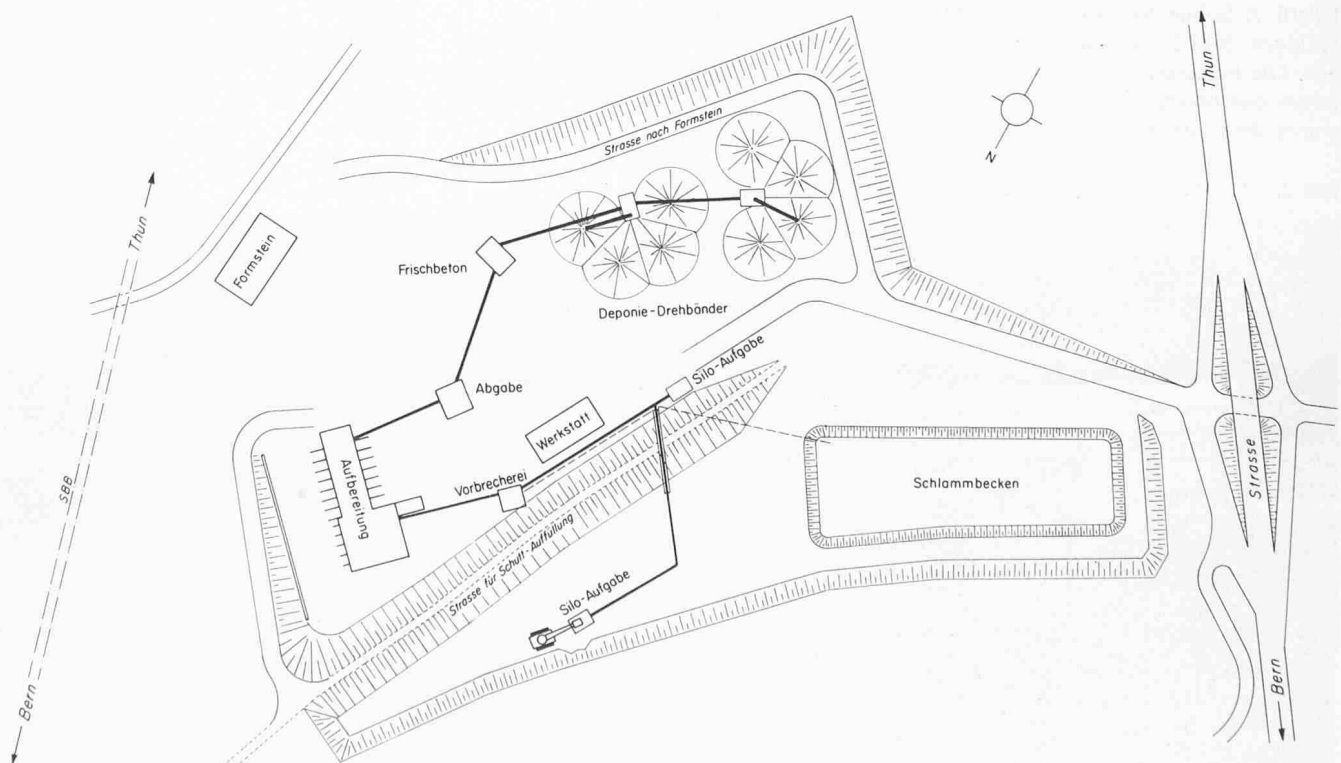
Lageplan der Anlagen der Bendicht Kästli & Söhne AG, Kieswerk Rubigen, Frischbeton AG und Formstein AG
